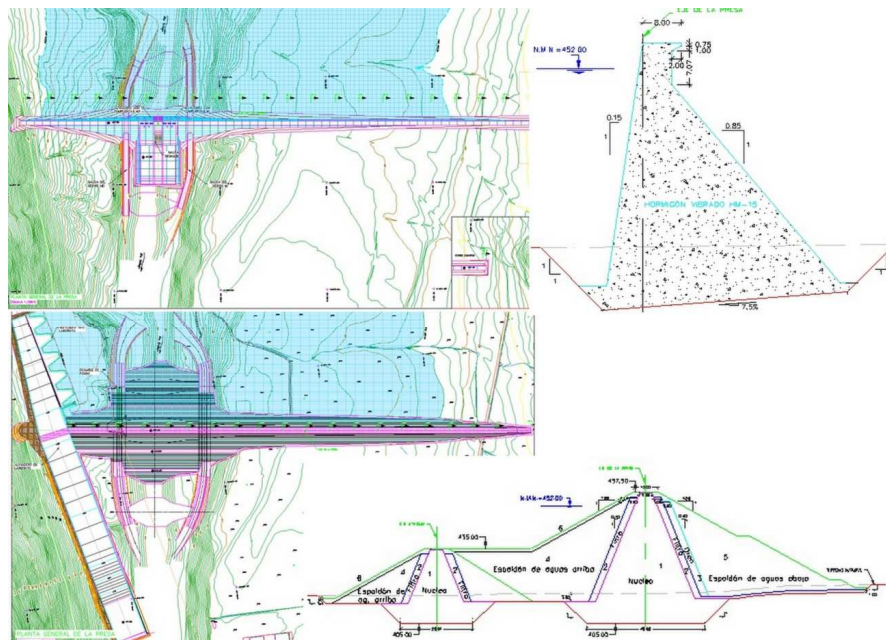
Planta y sección tipo. Materiales sueltos y hormigón vibrado
